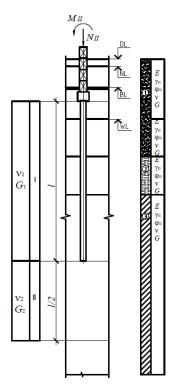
Схема к расчету свайного фундамента по деформациям (при низком ростверке)
